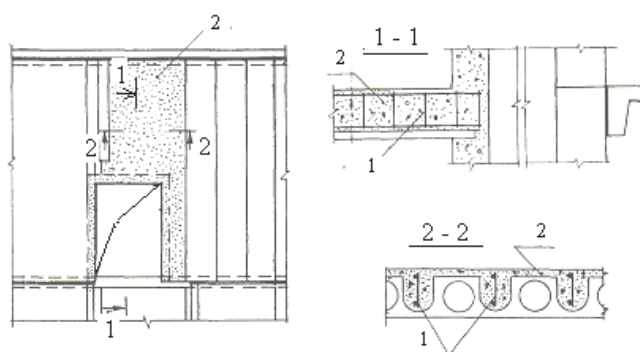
Устройство проема в перекрытии из многопустотных плит
